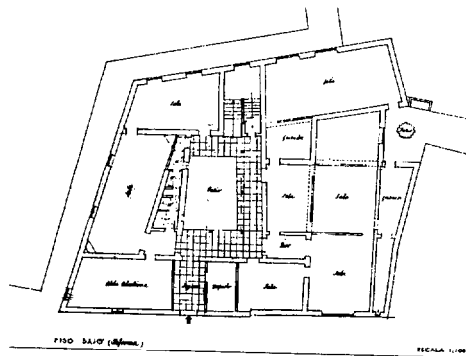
S. Zuazo. Anteproyecto. Planta baja.
